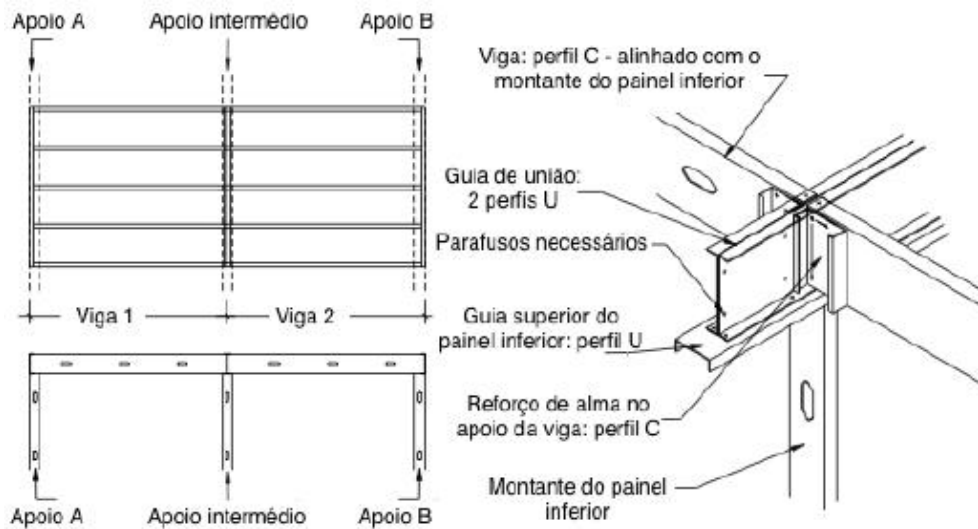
Planta, alçado e pormenor de uma viga simplesmente apoiada (Rego, 2012)
